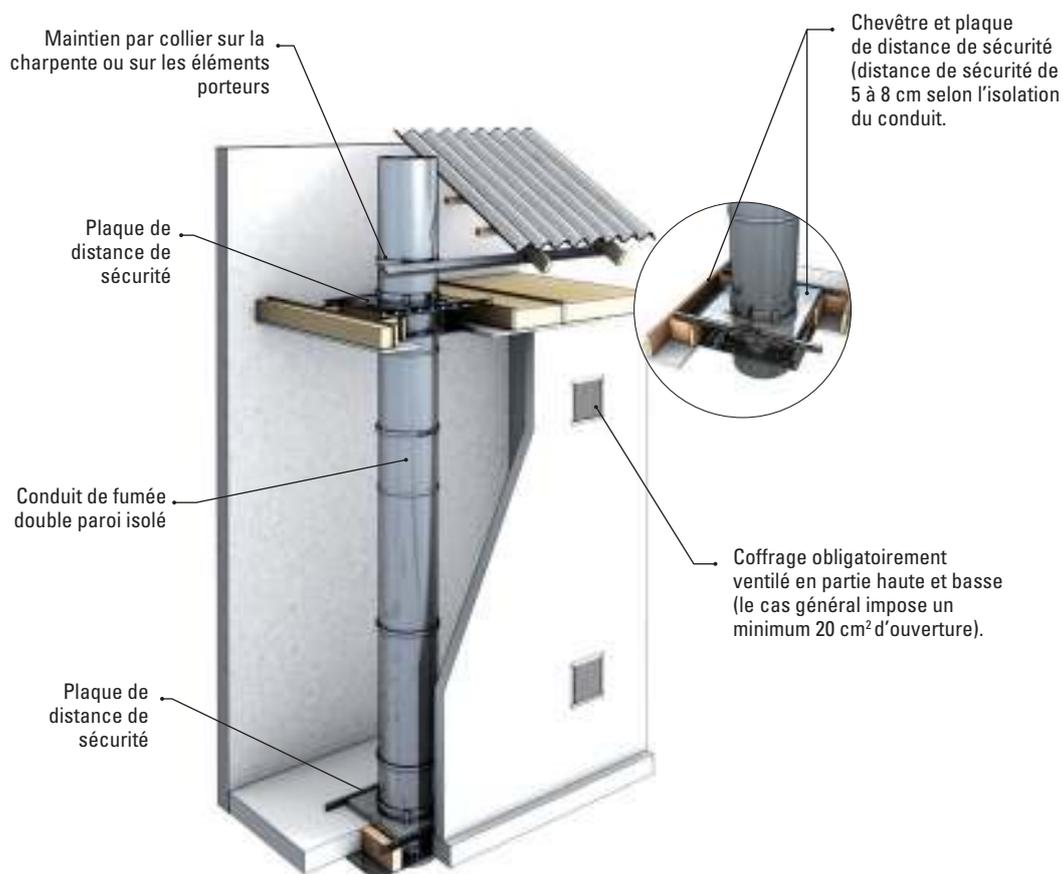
Exemple de coffrage ventilé d'un conduit de fumée métallique
